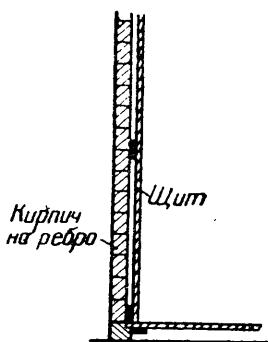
Утепление стен барака наружной кирпичной стенкой
